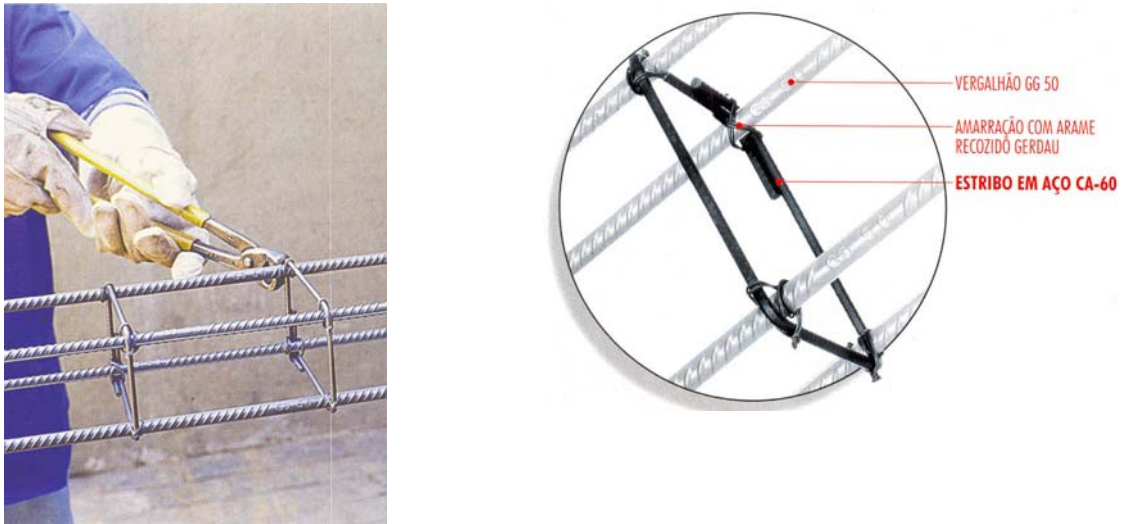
Armadura pronta para colunas (Catálogos Gerdau).
